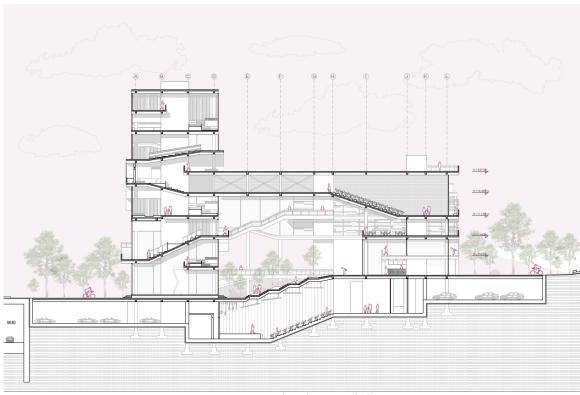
Corte Longitudinal Sur. Elaboración propia.
